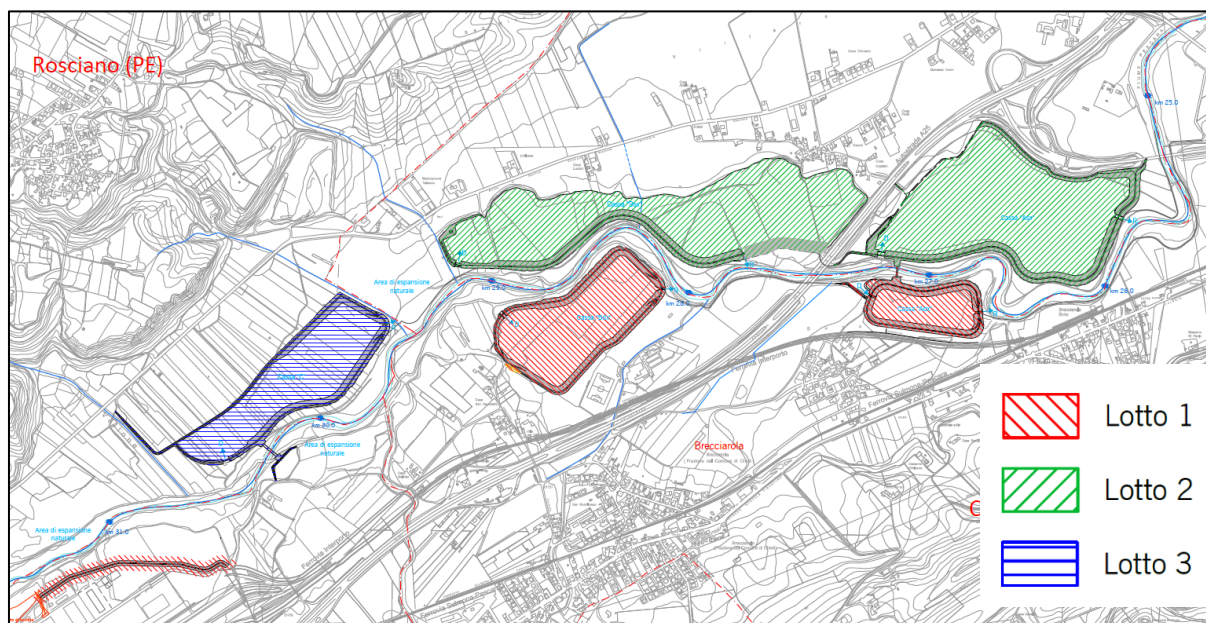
Planimetria di progetto con indicazione della suddivisione in lotti funzionali.
